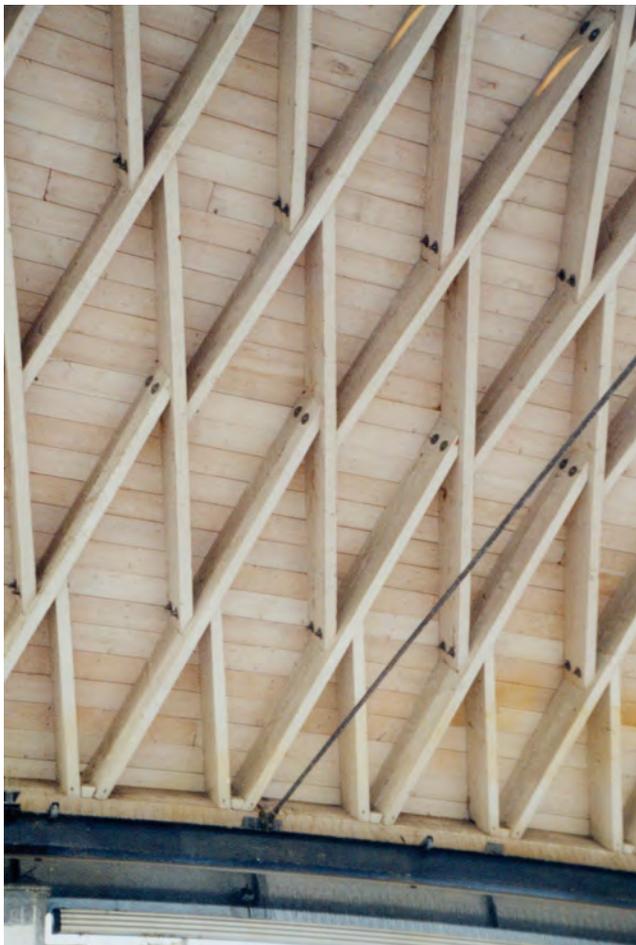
Ostfildern-Nellingen, Markthalle, Lamellenstruktur mit zweifacher Verschraubung
